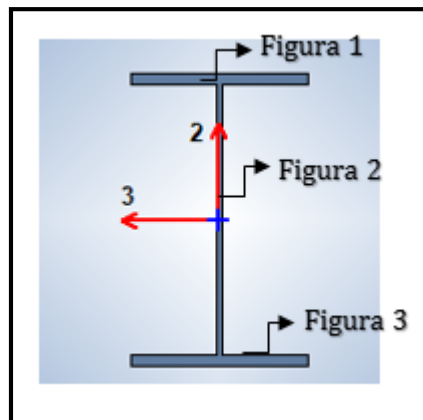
Viga secundaria 2 con pórticos arriostrados, figuras para cálculos.
